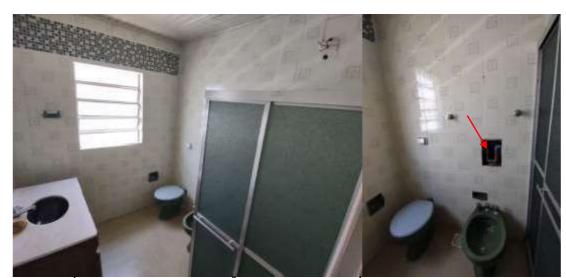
ÁREA INTERNA – EDIFICAÇÃO PRINCIPAL-SANITÁRIO: Louças originais existentes, tubulação exposta recomenda-se o fechamento do vão e posterior revestimento cerâmico.
